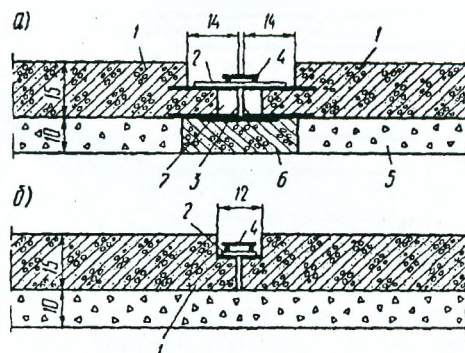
Конструкция стыков сборных железобетонных плит: а – стык в шве, параллельном урезу воды; б – в шве перпендикулярном урезу воды; 1 – железобетонные плиты; 2 – соединительный стержень; 3 – закладная деталь в подкладке; 4 – арматурная сетка; 5 – щебеночная или гравийная подготовка; 6 – подкладка; 7 – закладная деталь в плите
